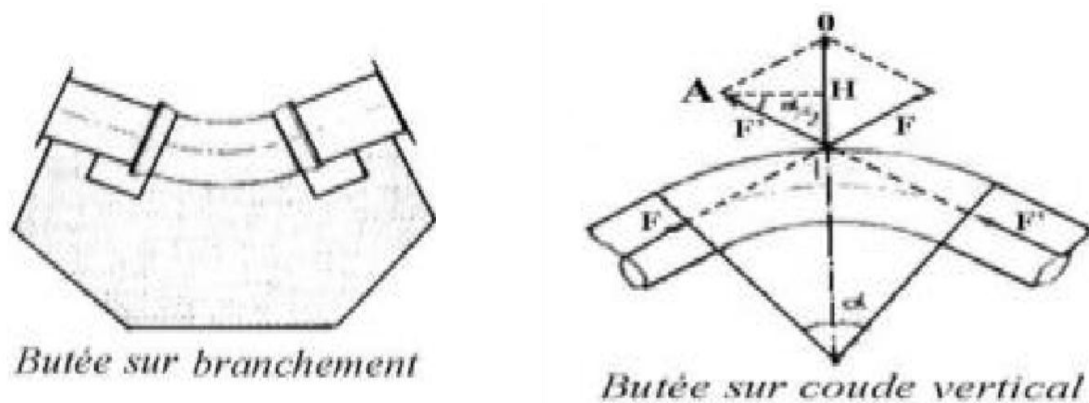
Butée sur branchement et butée sur coude vertical.
